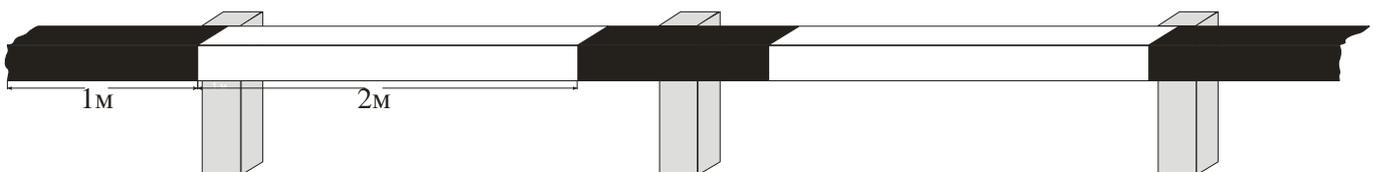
Форма, цвет и размеры вертикальной разметки 2.5, наносимой на железобетонное барьерное ограждение на опасных участках.
